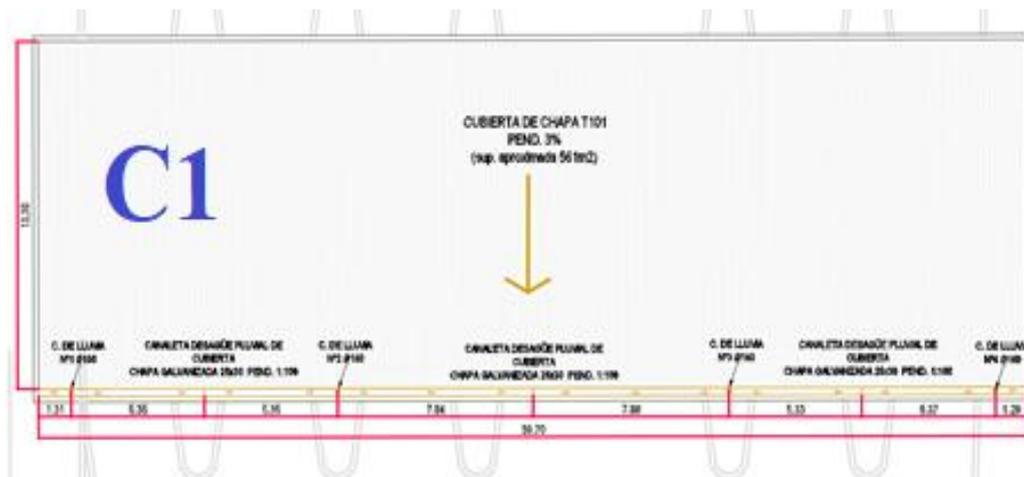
Planta de techos Edificio C1 a desaguar en paso fronterizo La Quiaca - Provincia de Jujuy
